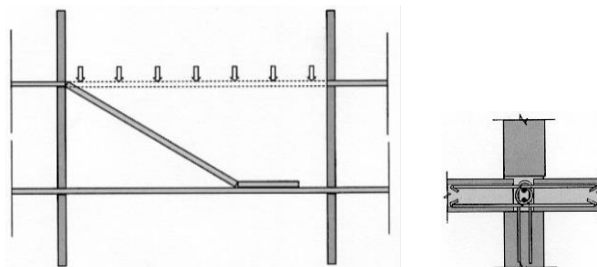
prevenzione di collasso locale (caduta di solaio o copertura) mediante adeguati collegamenti d'estremità
